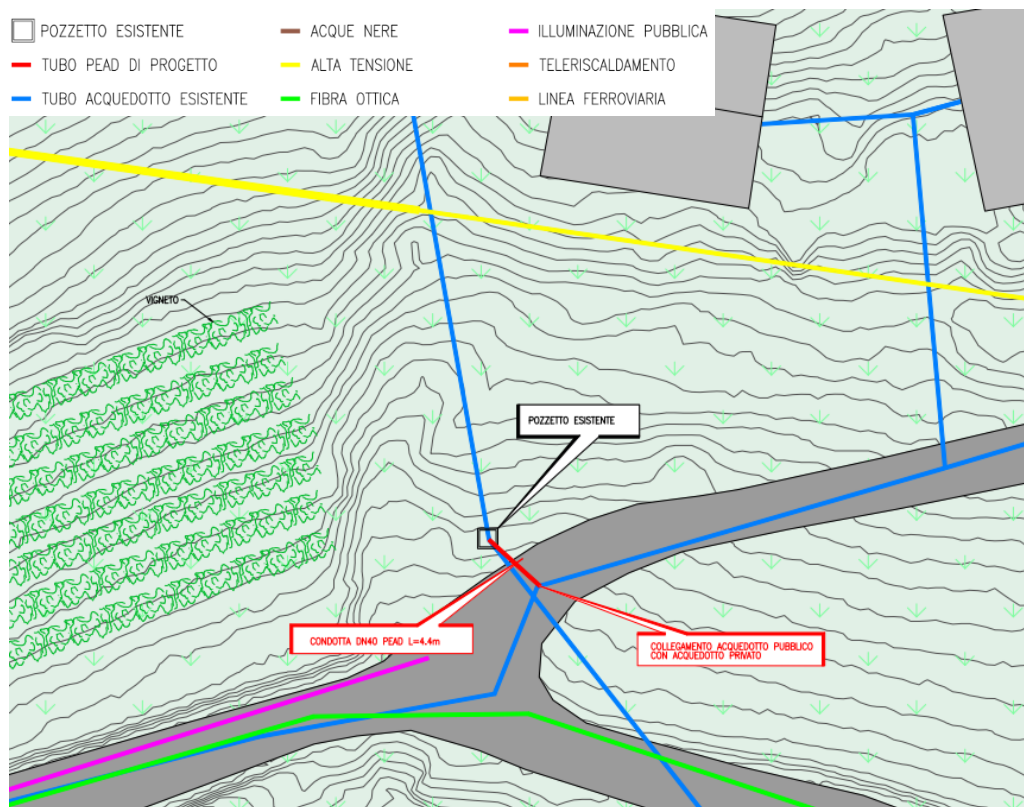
Estratto planimetria sottoservizi sorgente S7A
